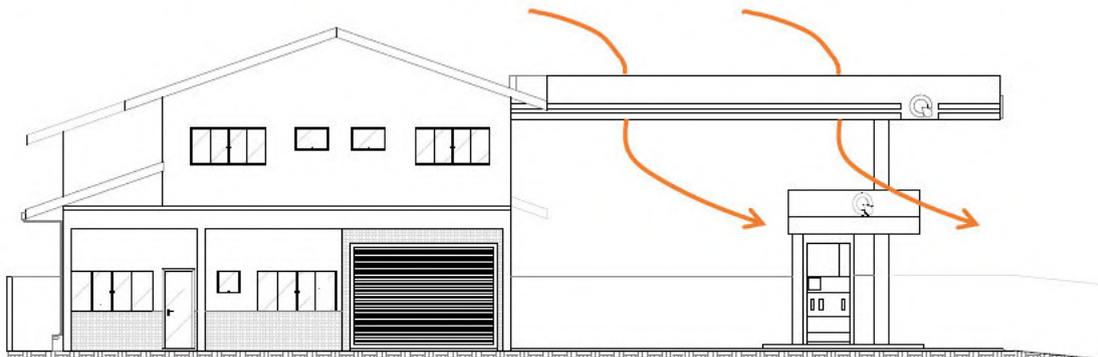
Fachada do imóvel, com detalhe de passagem de ventilação
